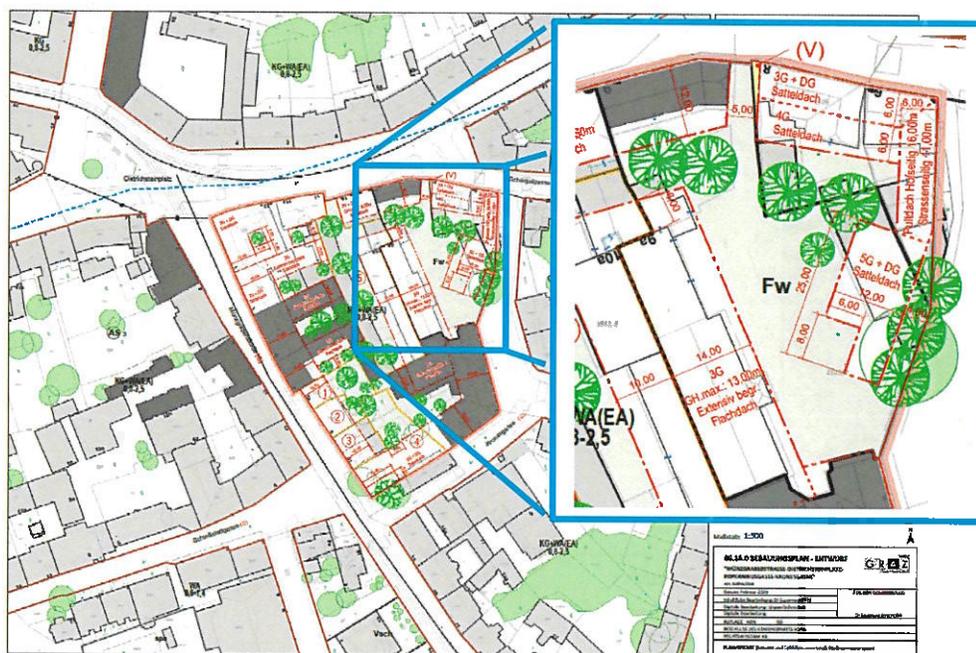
06.16.0 Bebauungsplan - ENTWURF
